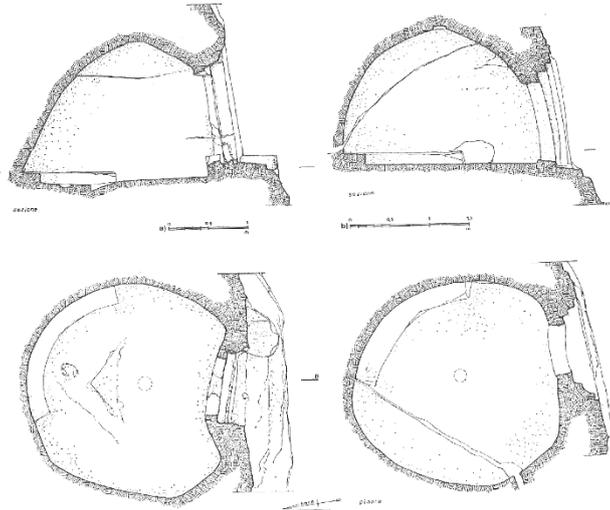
Planimetria e sezione delle Tholoi A e B rinvenute a monte Campanella (da La Rosa 1997f, p.147).
